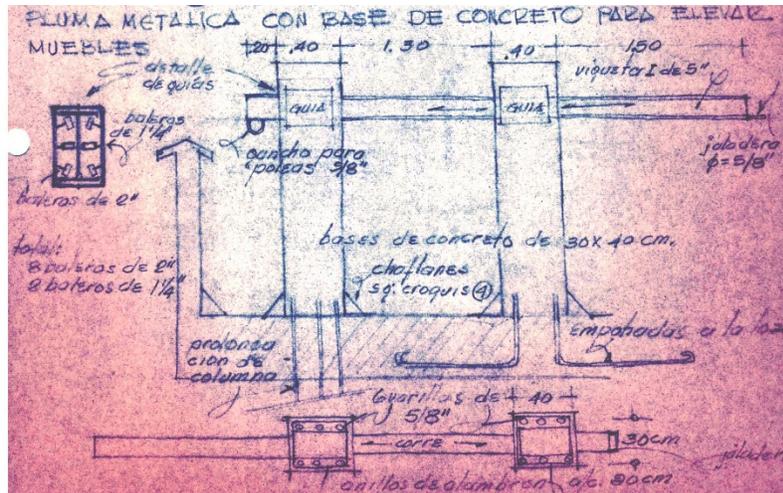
Croquis detalle de la pluma metálica con base de concreto para elevar muebles por la fachada del edificio ubicado en Horacio núm. 1834
